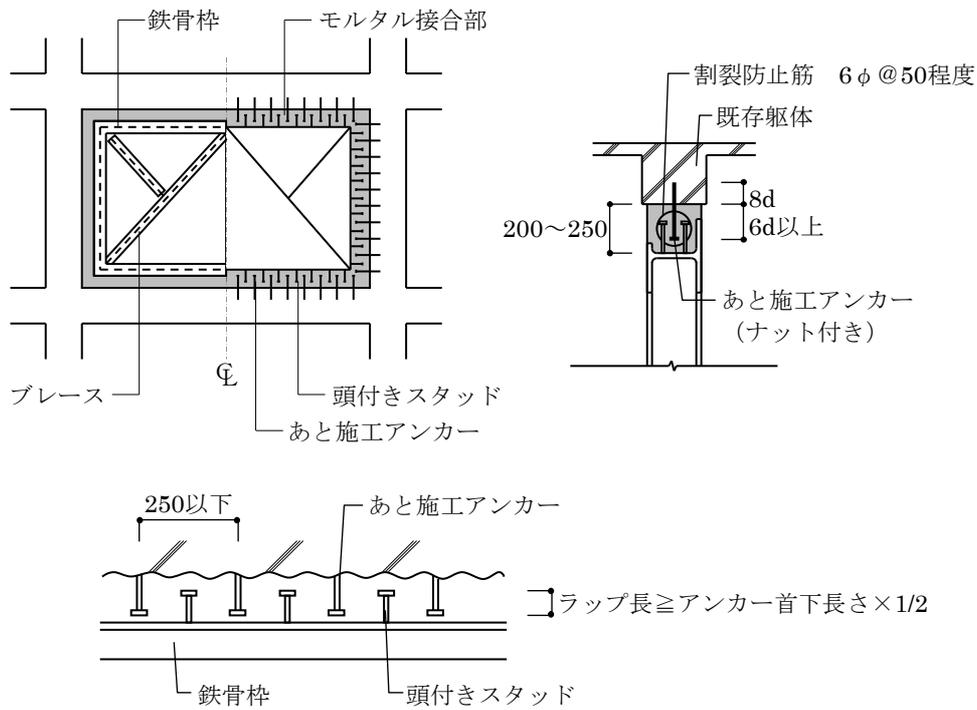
枠付き鉄骨ブレース補強の構造詳細
